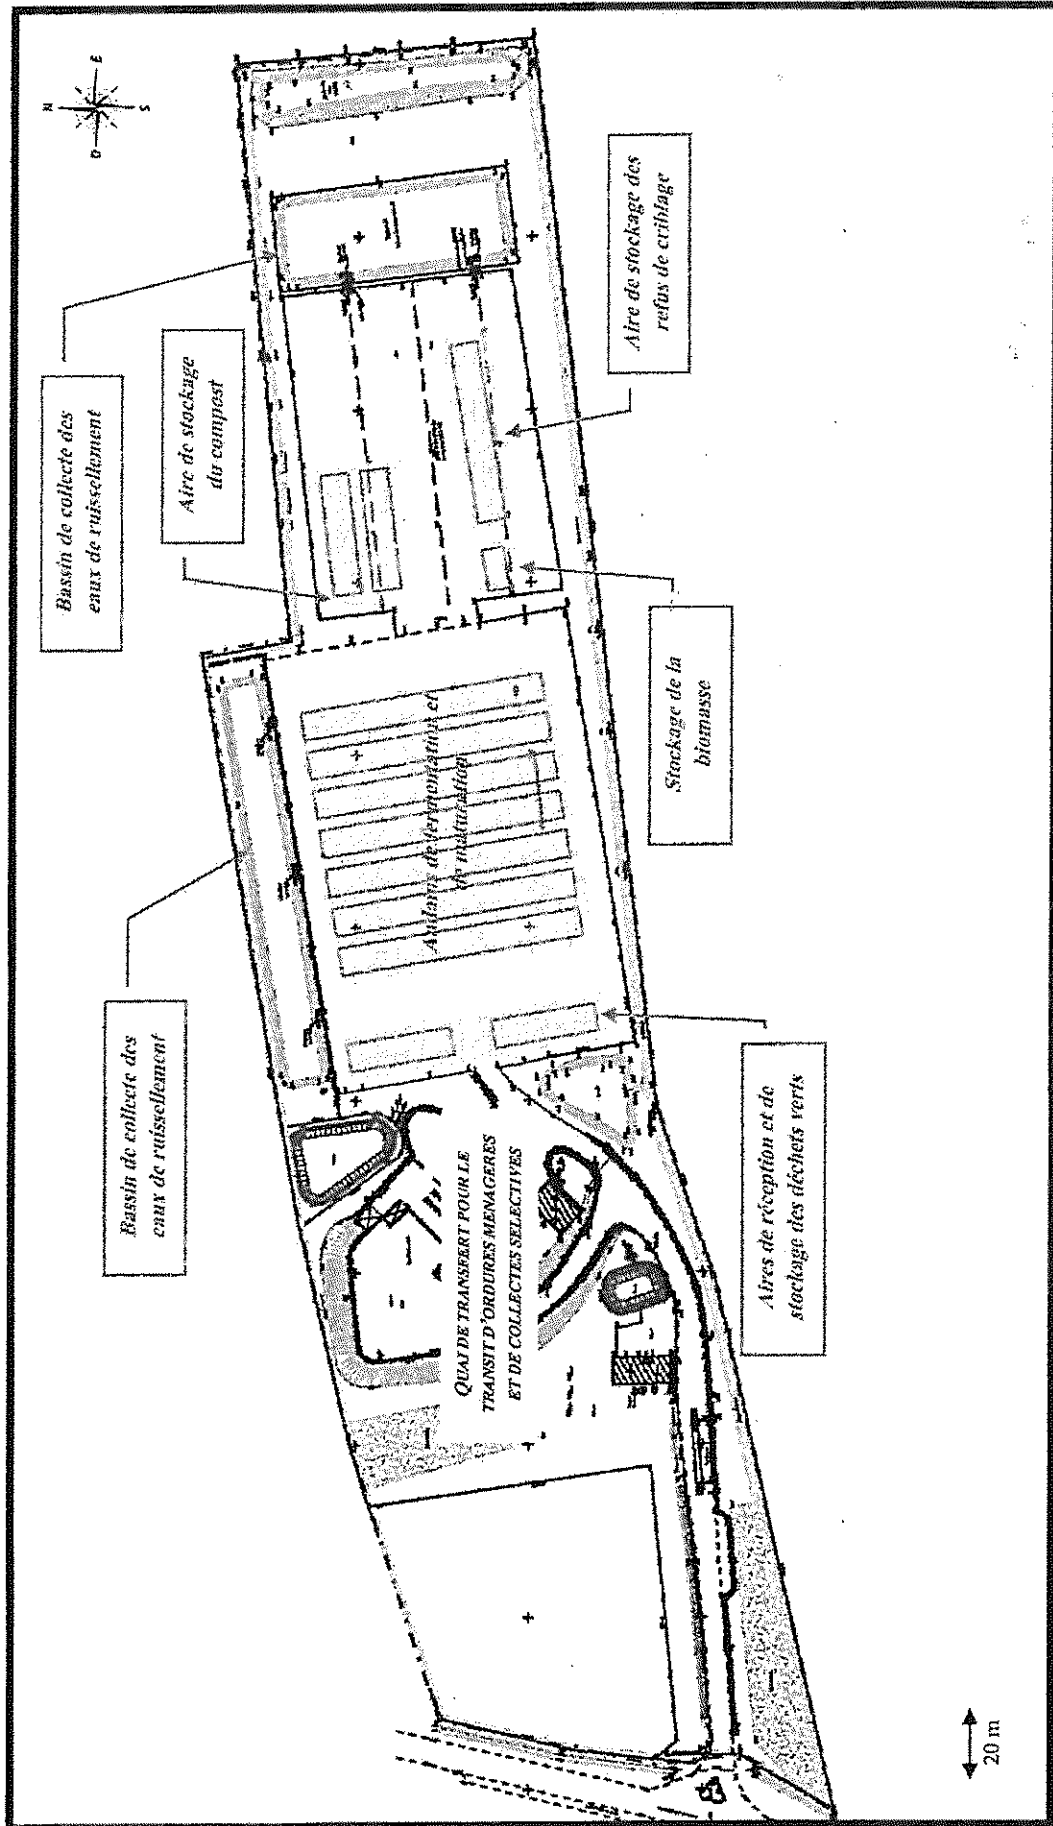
PLAN DE MASSE – SITUATION ACTUELLE
